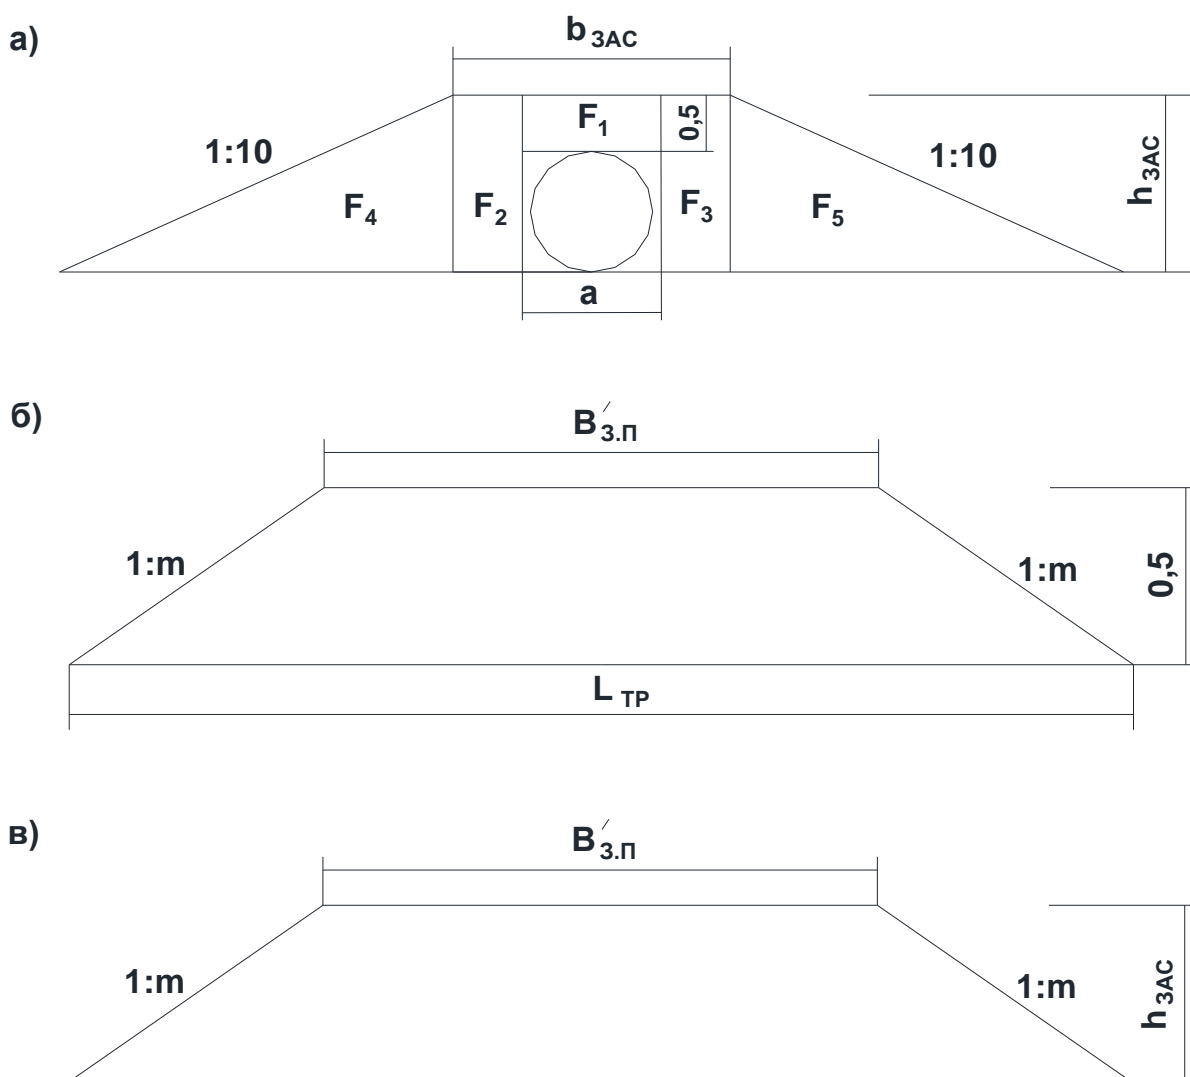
Схема к расчёту объёмов работ на засыпку водопропускной трубы:
